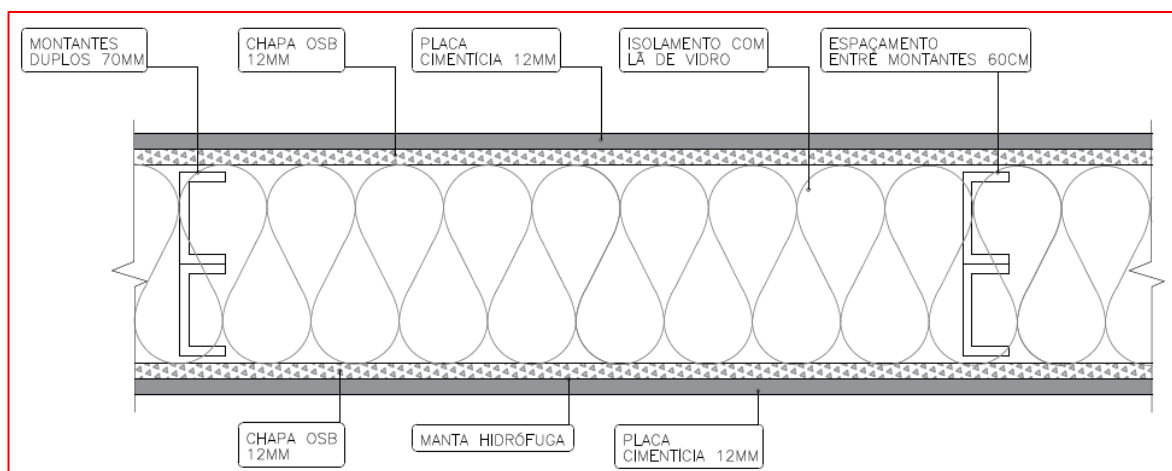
Detalhe da parede em Steel Frame. Fonte: Projeto.
